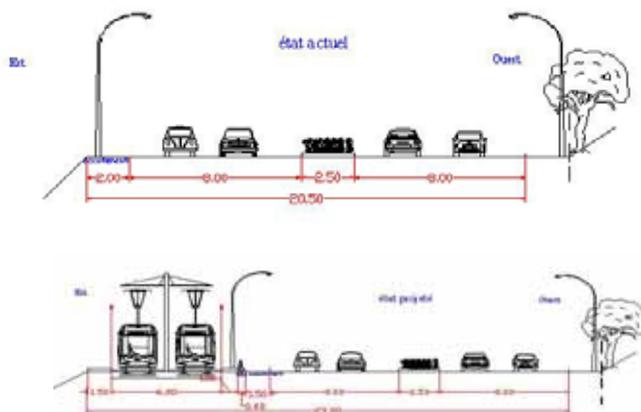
Implantation du tramway sur tronçon de la cité universitaire à zarzara
